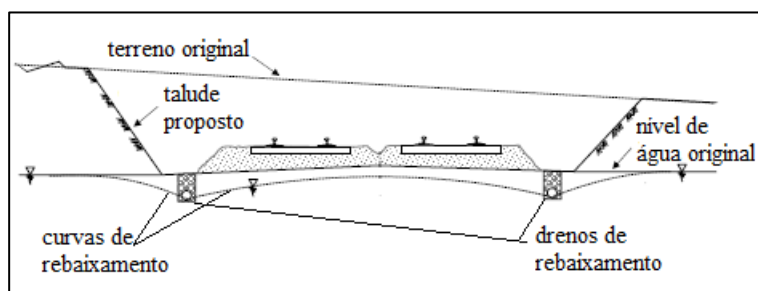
Drenos longitudinais profundos posicionadas nas bermas da ferrovia (adaptado de ARTC, 2006)
